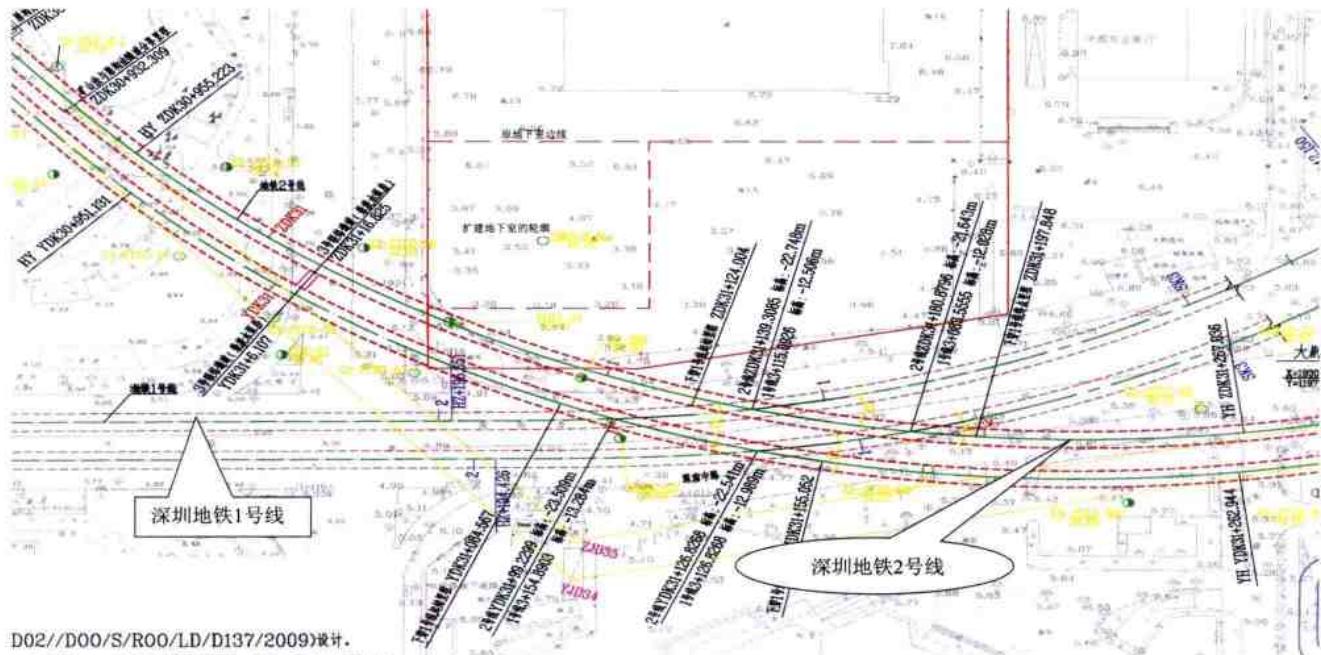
燕大区间下穿地铁 1 号线科大区间平面图
